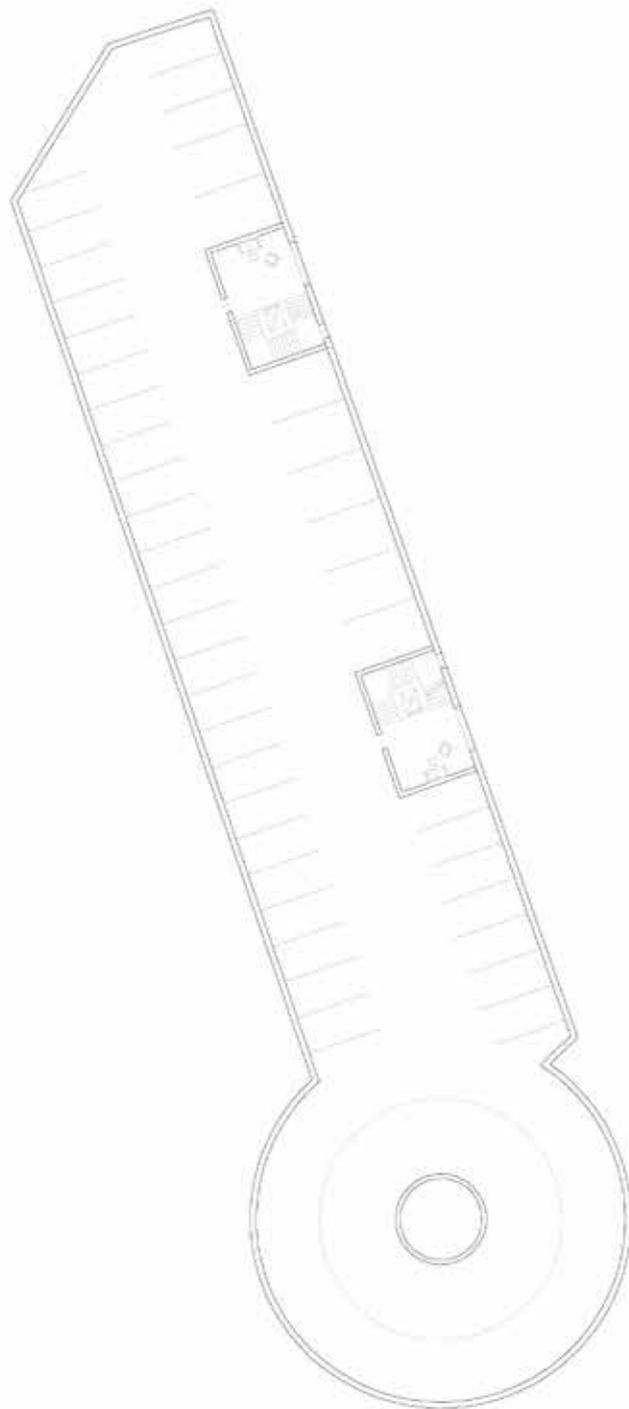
Übersichtsplan und Grundriss M 1:500
